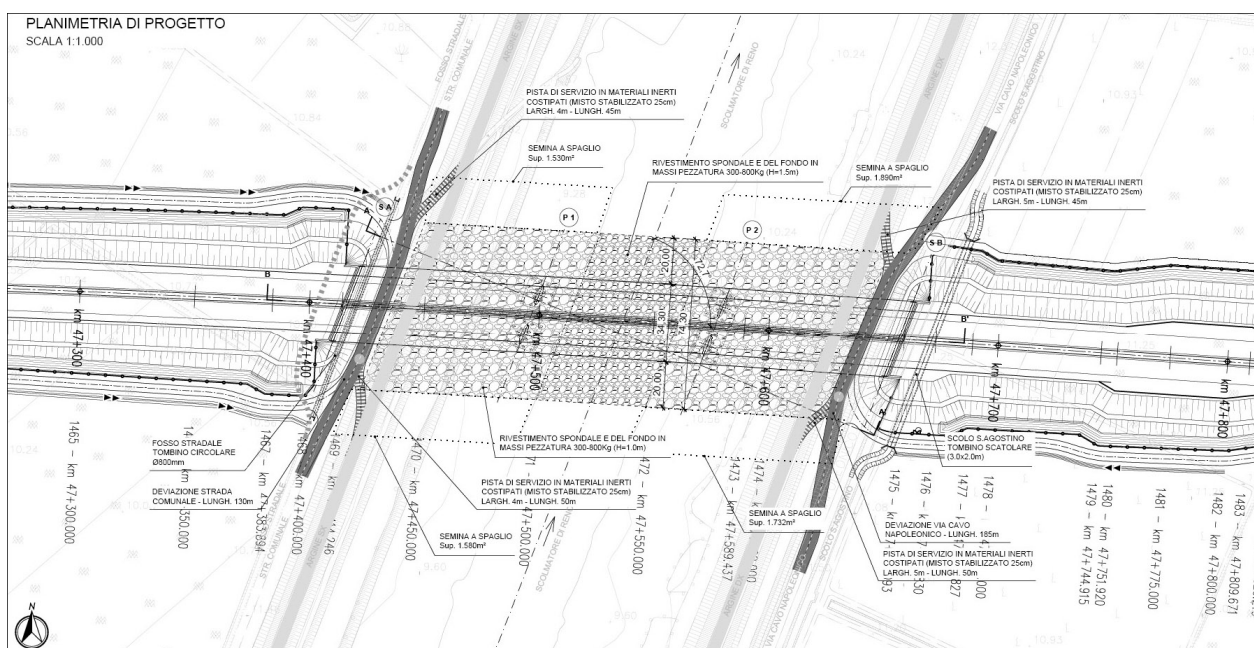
PLANIMETRIA STATO DI PROGETTO DELL'ATTRAVERSAMENTO IN PONTE DELLO SCOLMATORE RENO (ESTRATTO DALL'ELAB. 0715_PD_0_A44_AWS18_0_WW_PZ_02_A)
